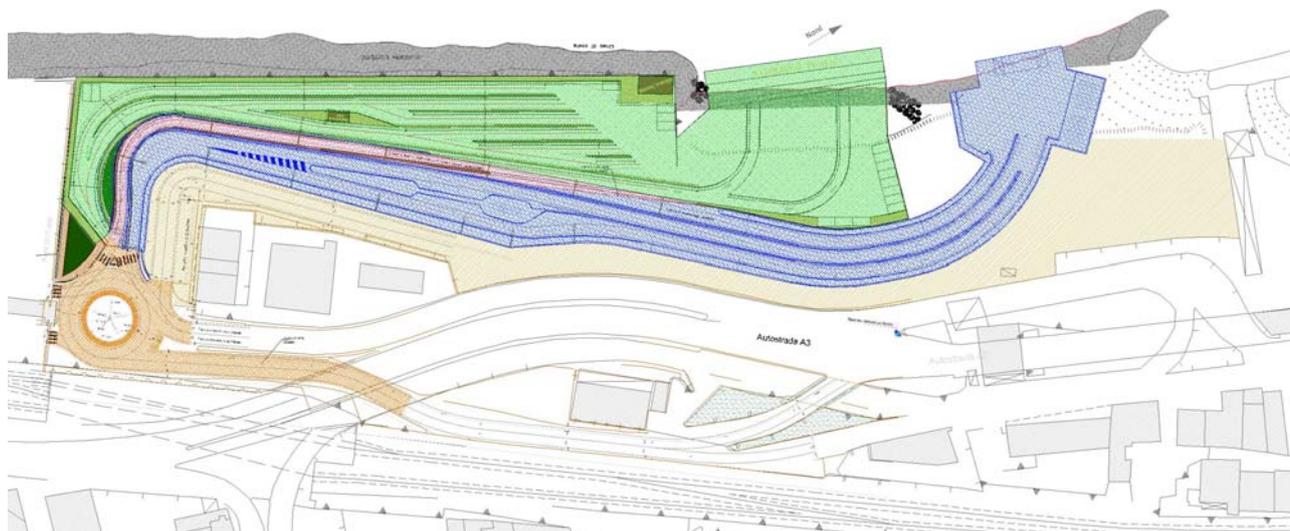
Planimetria generale dell'opera con destinazione delle aree
